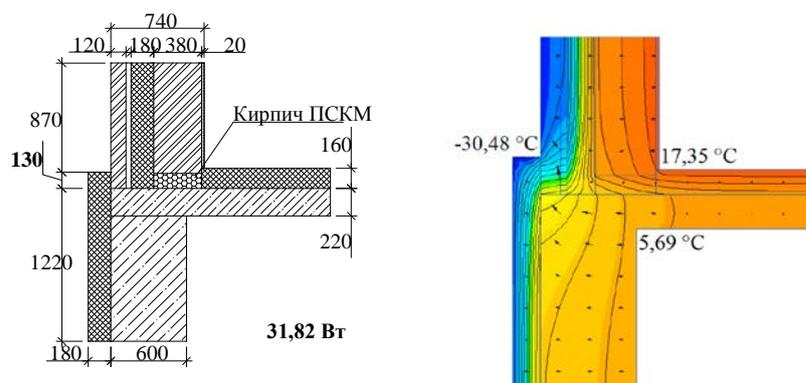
Цокольный узел с теплоизоляцией стены подвала (вариант 4)
